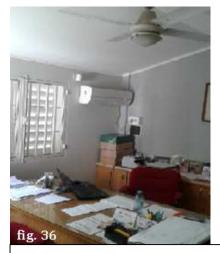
y fig.36 – Sector de Gerencia Gral, tipo de Iluminación y plano en Planta (fig.37).
